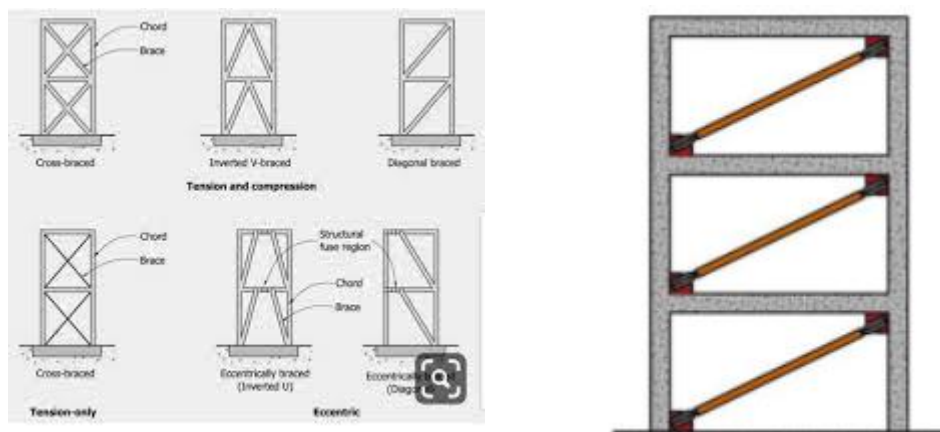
Contraventamentos em pórticos de betão armado, adaptado de [Google]
